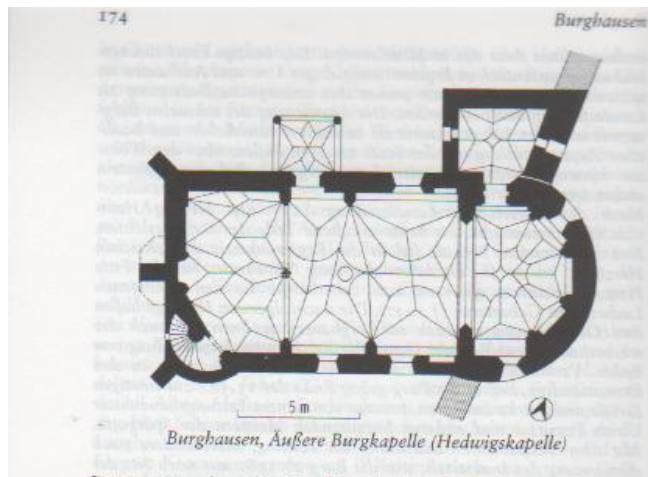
Grundriss Burghausen, Äußere Burgkapelle
